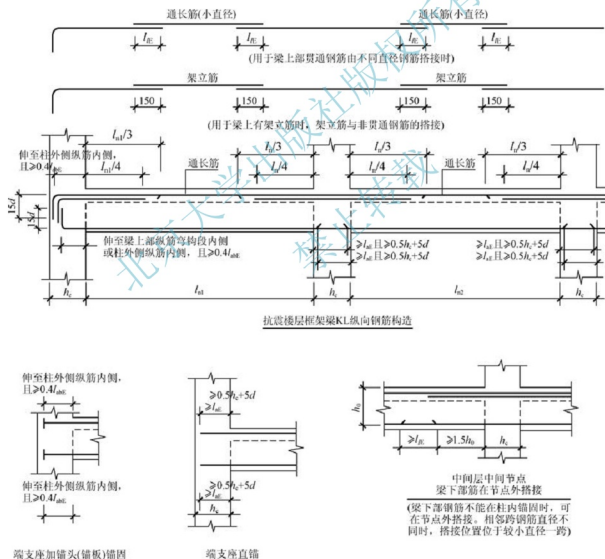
抗震楼层框架梁 KL 和屋面框架梁 WKL 钢筋构造
